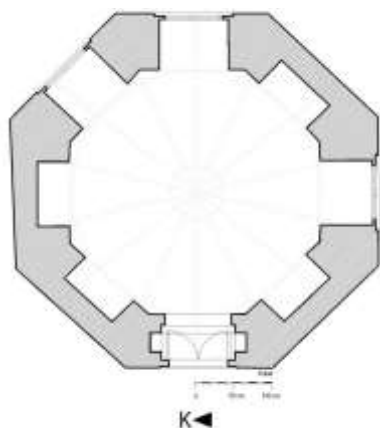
المؤقتخانه بجامع سواي-مسقط أفقي
